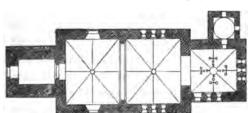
Kirchbaggendorf. Kirche. Grundriss. 1:667.
